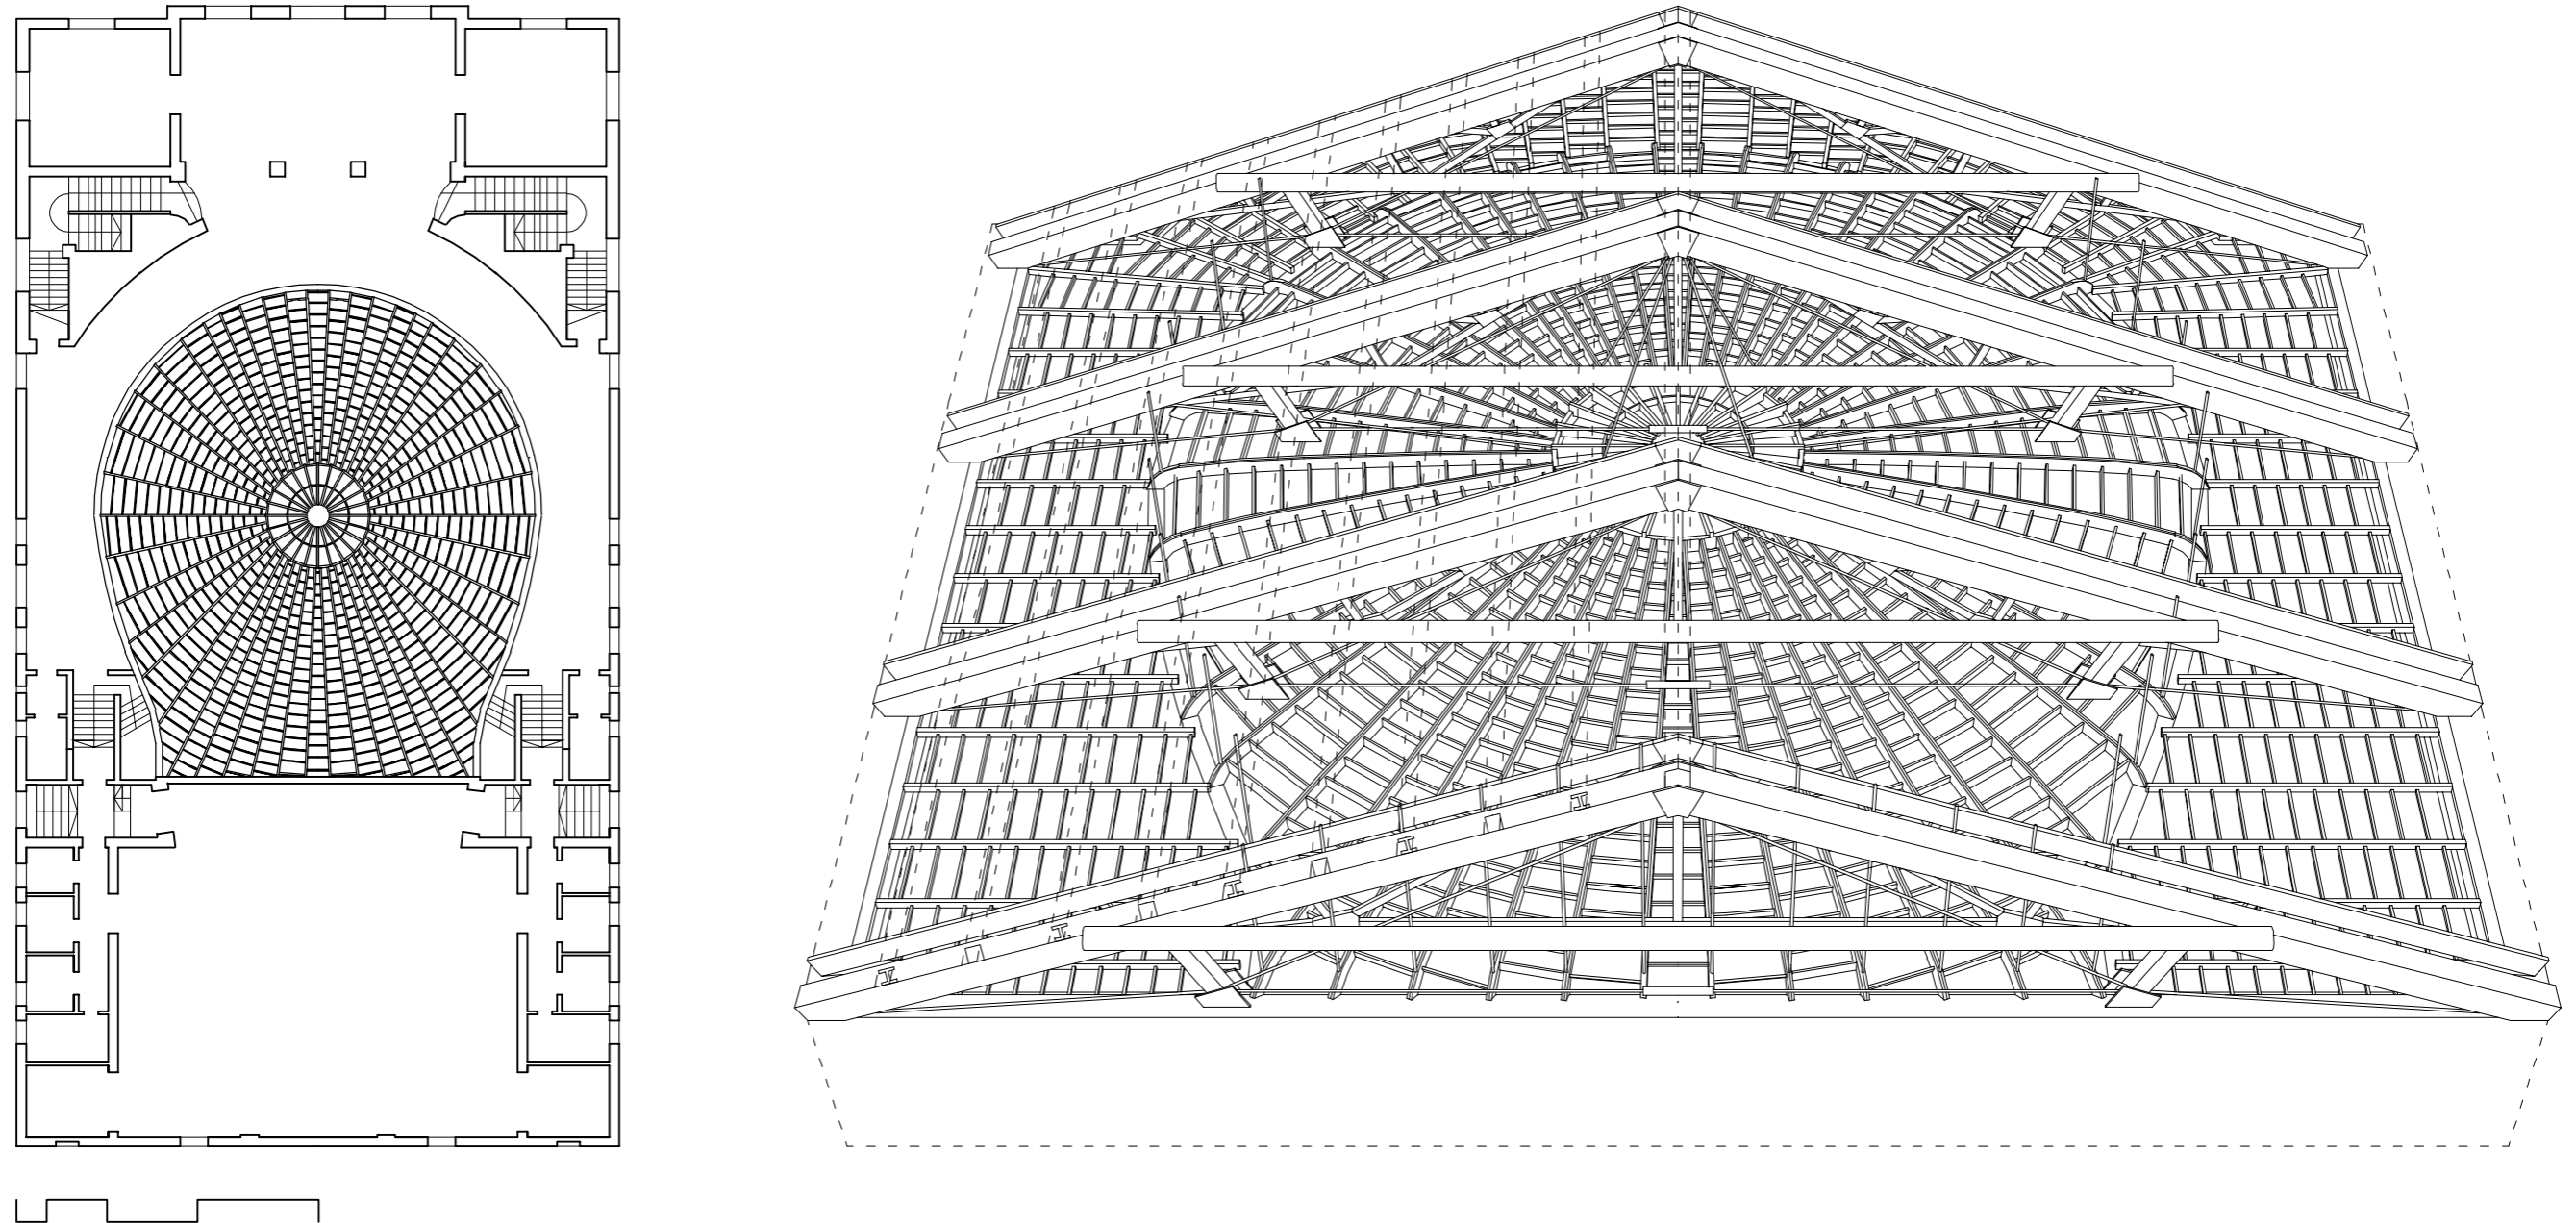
Teatro Sociale di Novi di Modena. Pianta del piano platea (ridisegno) con proiezione del plafone; rappresentazione prospettica del sistema di copertura della sala.
